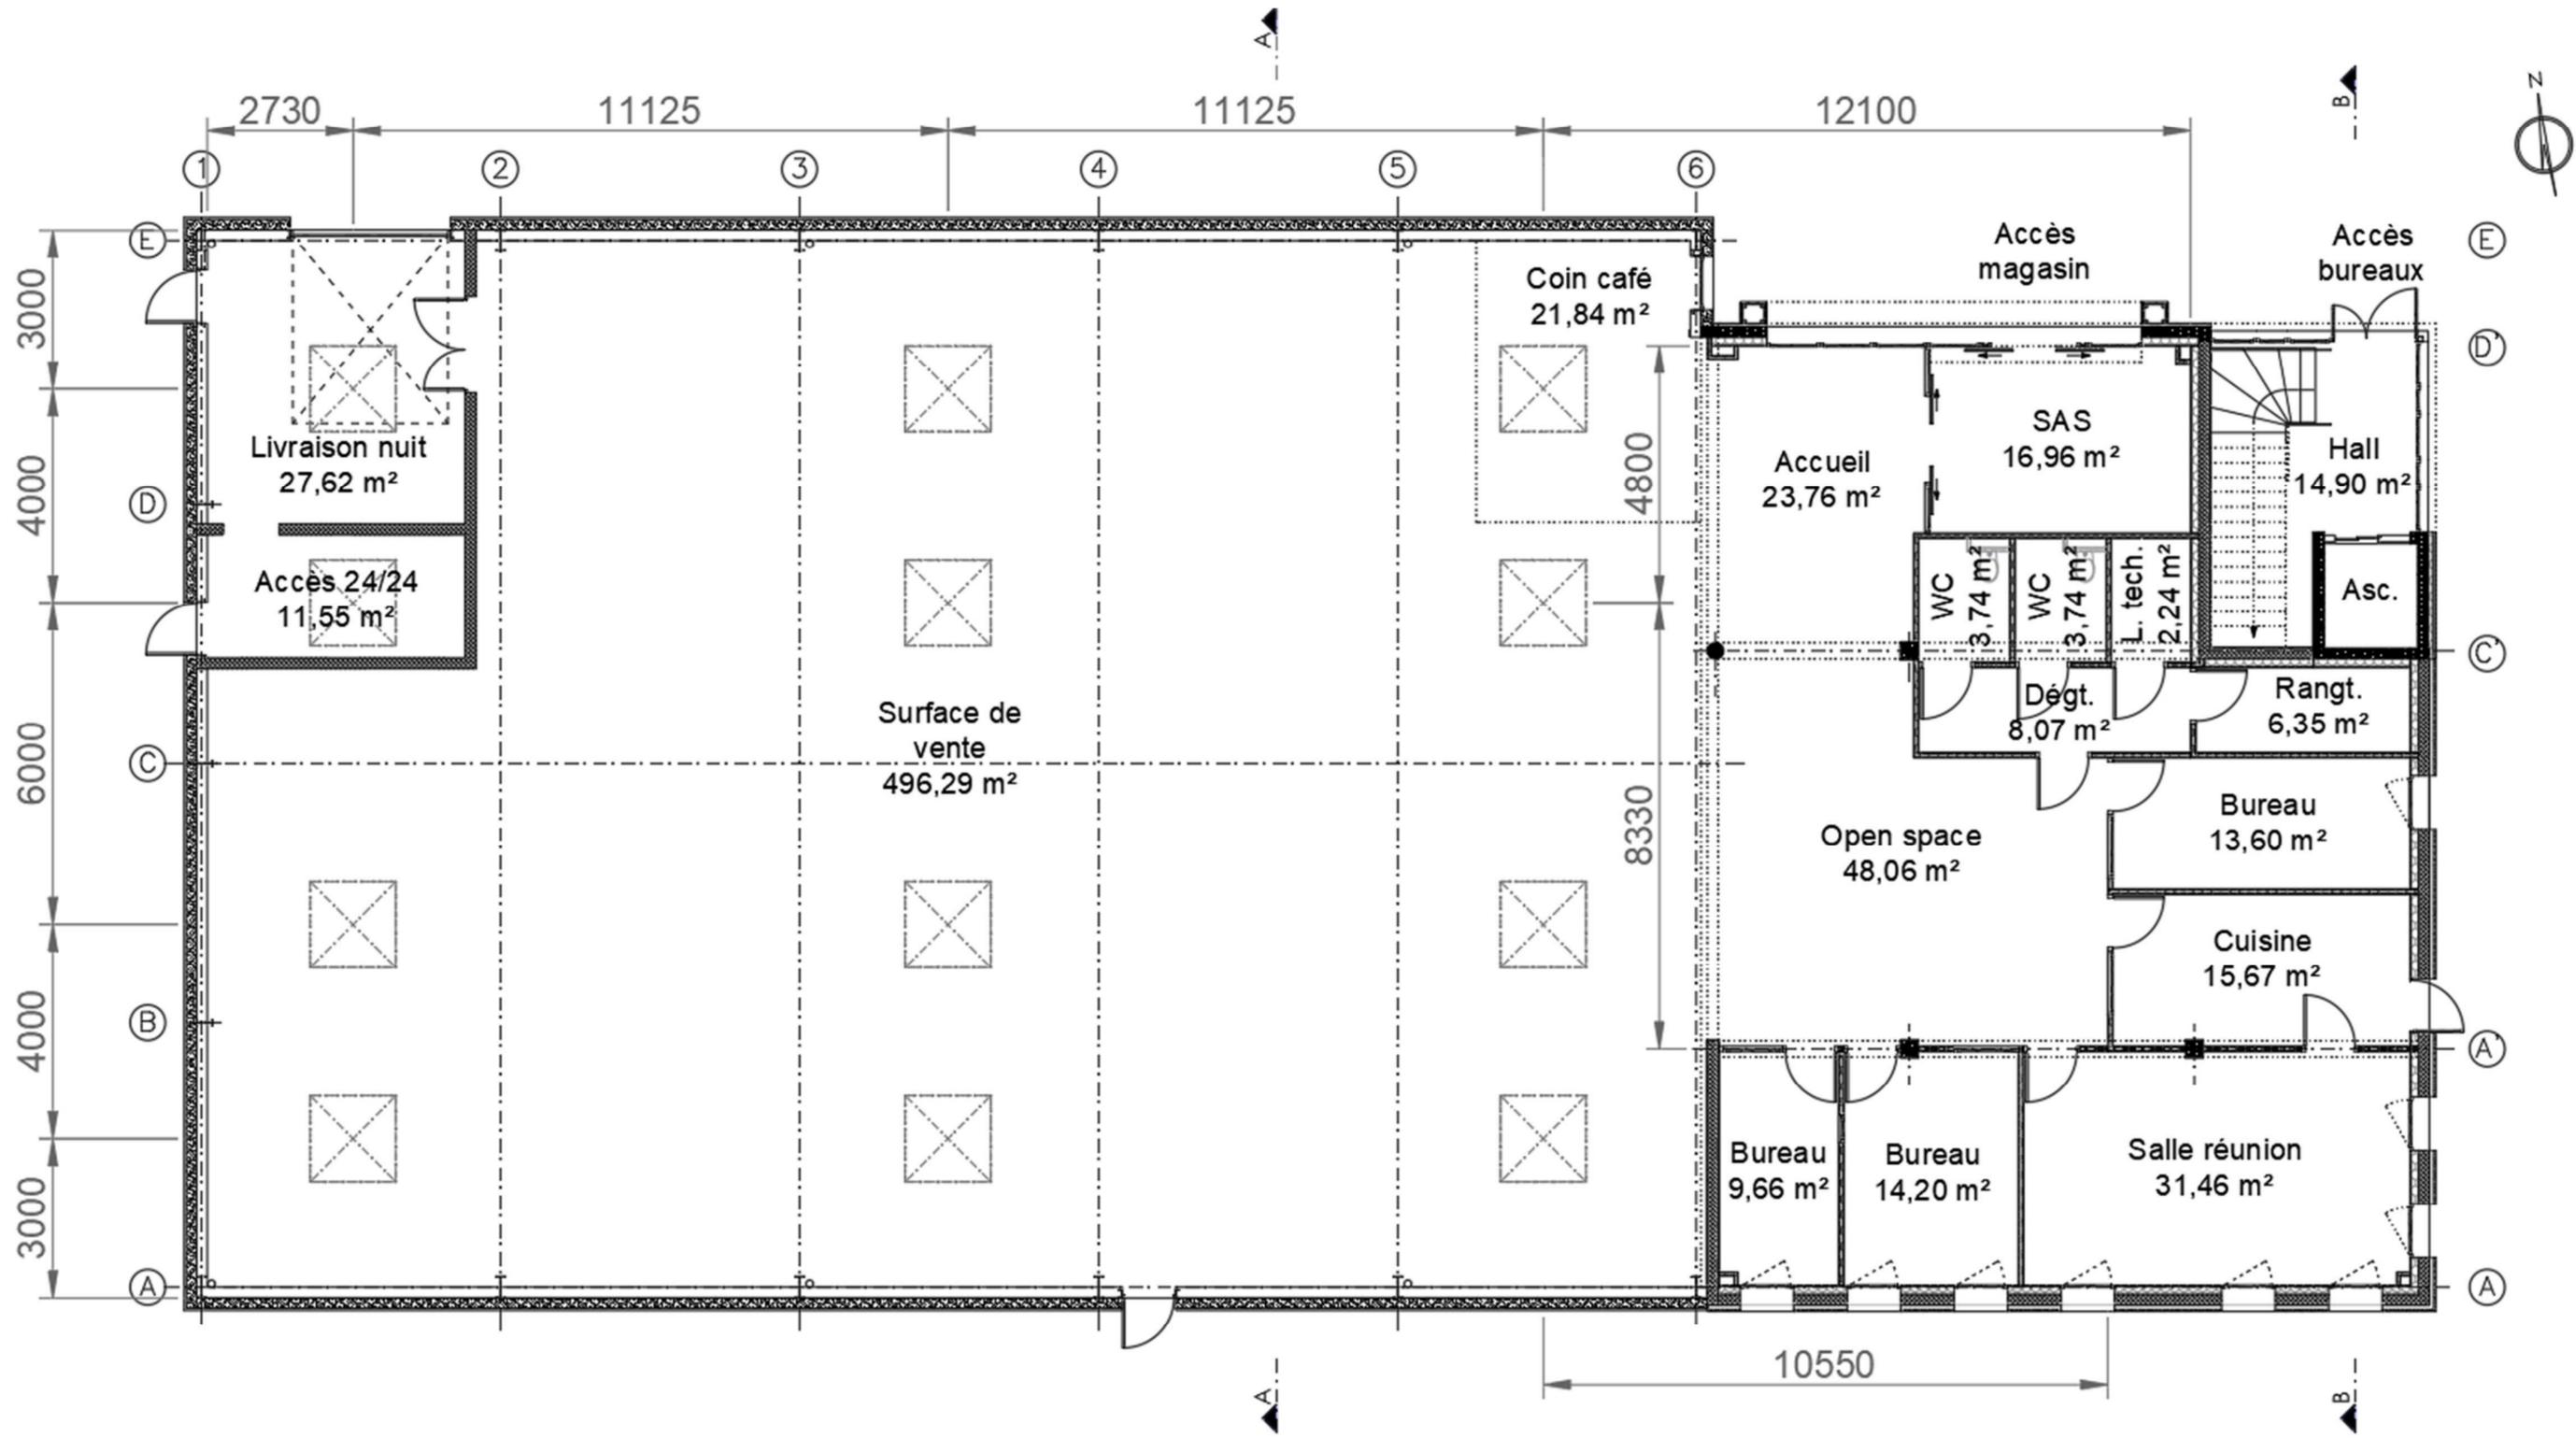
Rez-de-chaussée (avec positionnement des lanterneaux)
